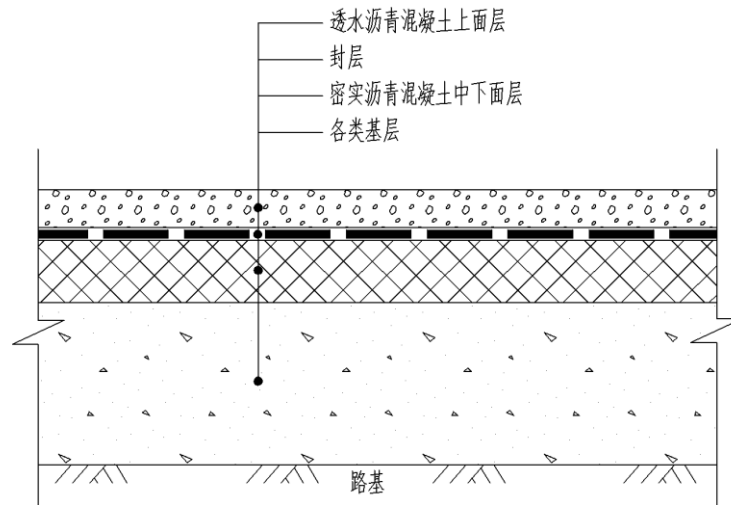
表层透水式透水沥青混凝土路面示意图
